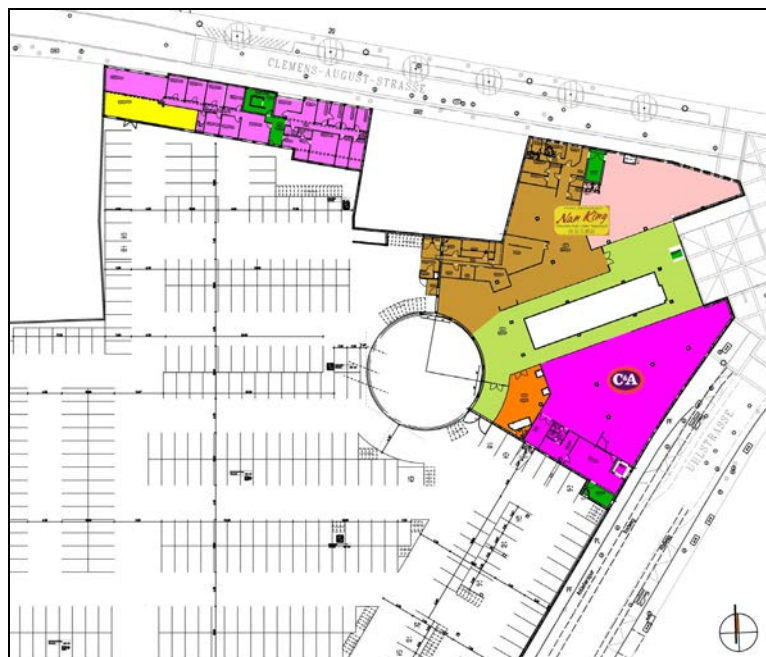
Planta primera (aparcamiento) y acceso a un centro comercial en Brühl
